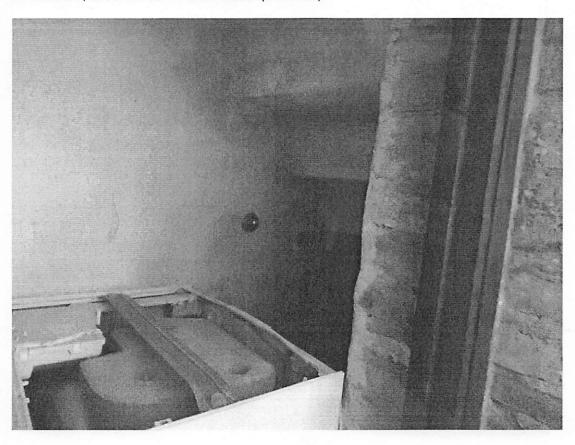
PIANO TERRA (foto n.17)
